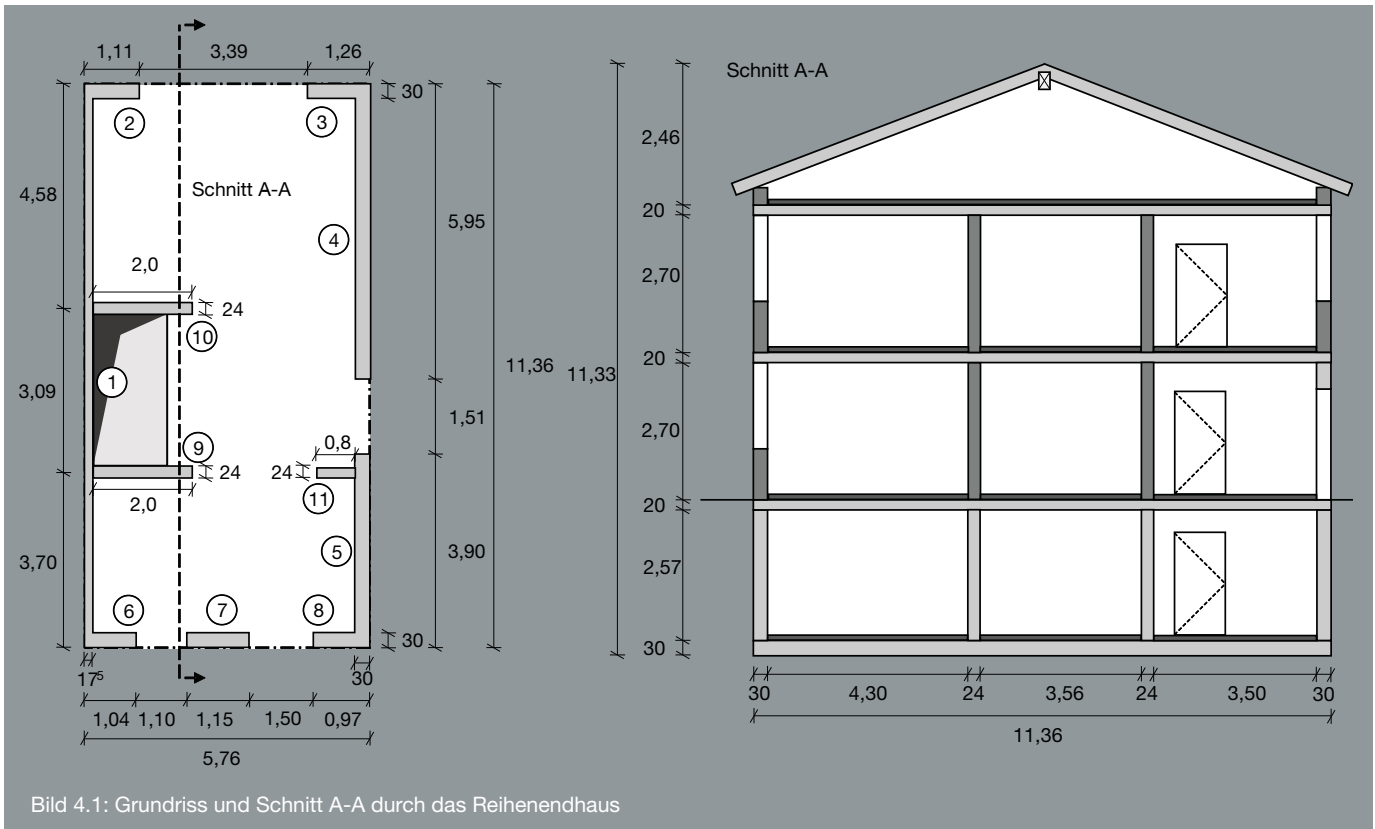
Grundriss und Schnitt A-A durch das Reihenhendhaus
